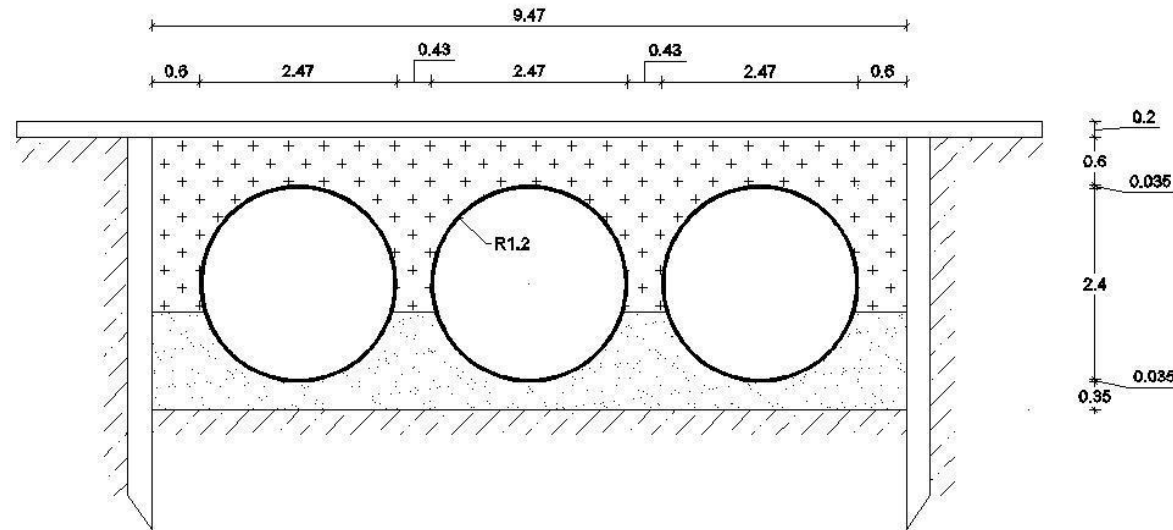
Sección tipo de las tuberías que discurren por la Av. Marina Marina Baixa
